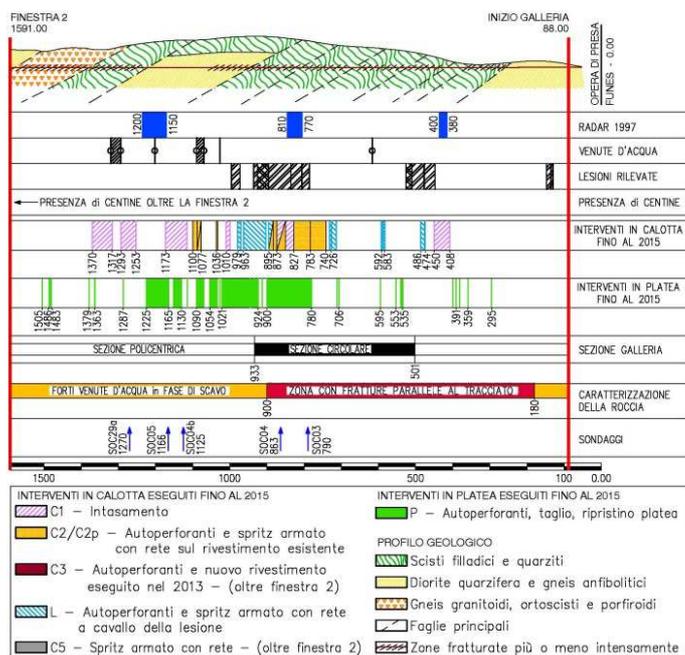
Profilo longitudinale di un tratto della galleria di derivazione dell'Impianto di Ponte Gardena
